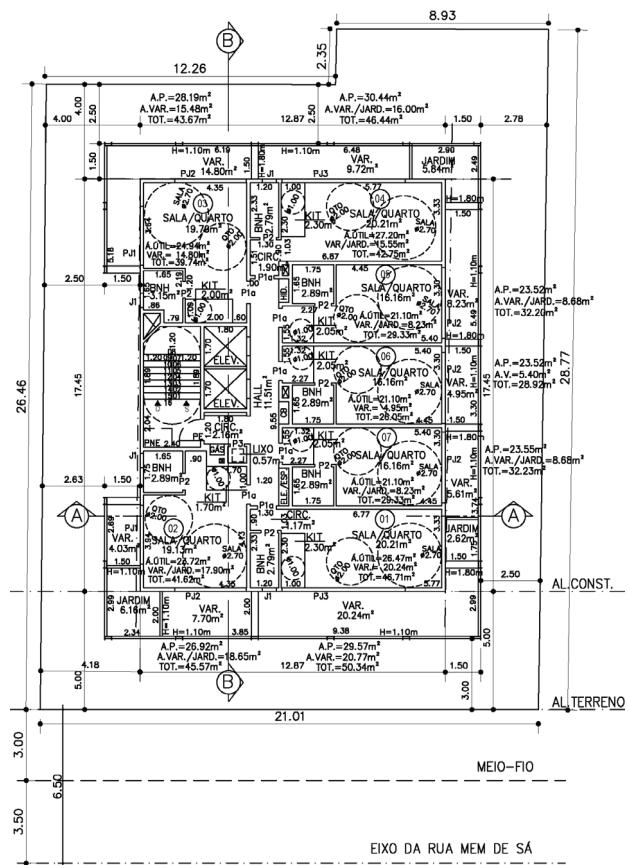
Pavt. Tipo – 8º Pavimento – Fonte Projeto Legal
